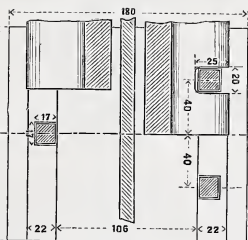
Grundriss der Unterlagsplatten an den Schienenstößen.
